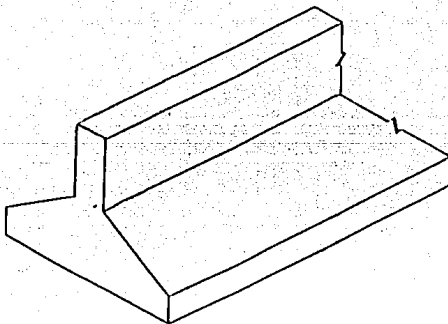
B.- ZAPATA CORRIDA DE CONCRETO
